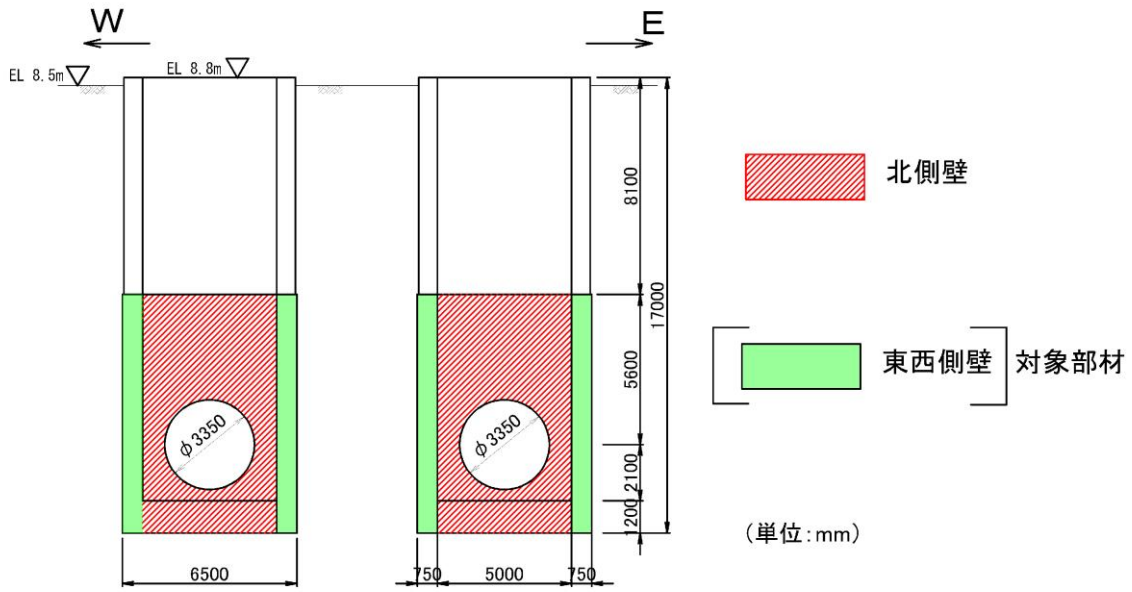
1号機取水槽評価対象部材断面図 (B-B断面)
